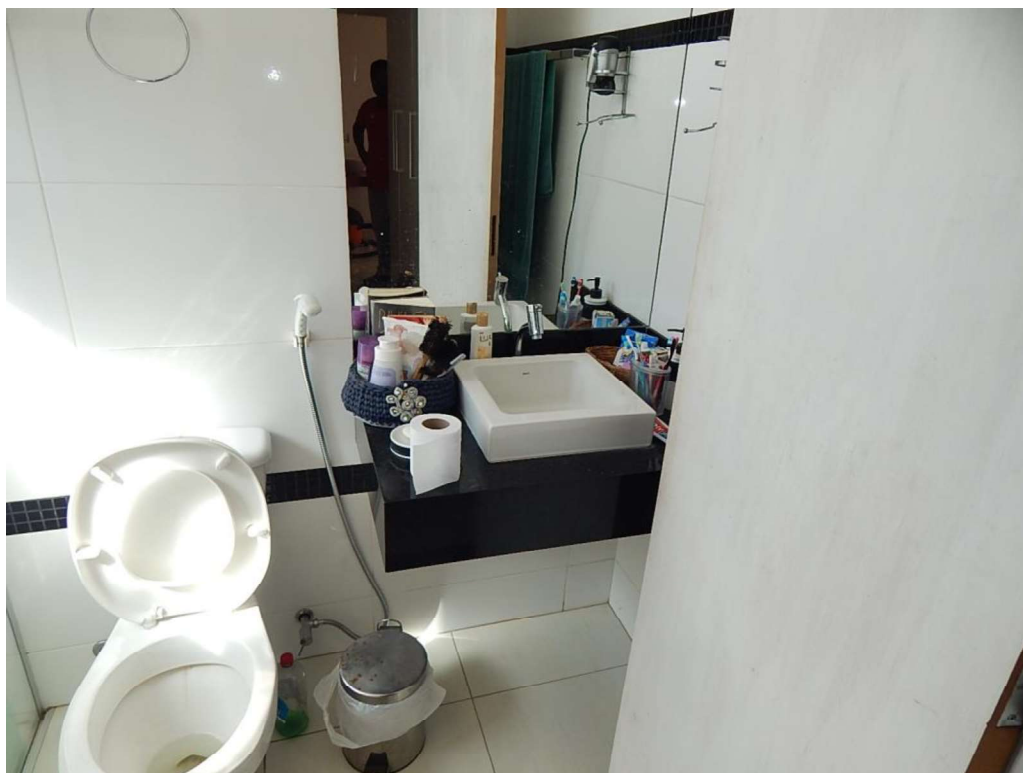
PARCIAL BANHEIRO SUITE TERREO
